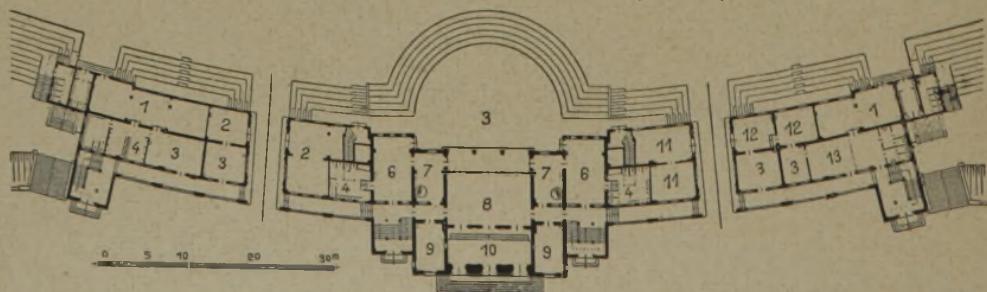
Grundriß des I. Obergeschosses. (1 : 1000.)
